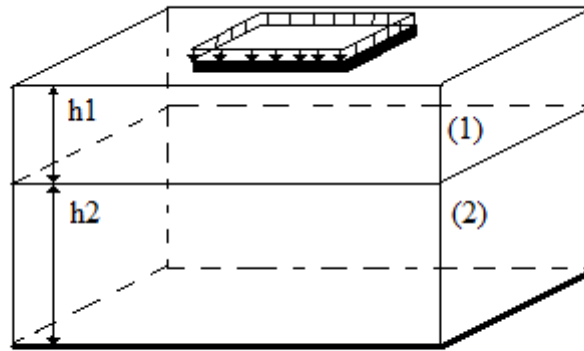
Plaque épaisse sur une fondation bicouche.
